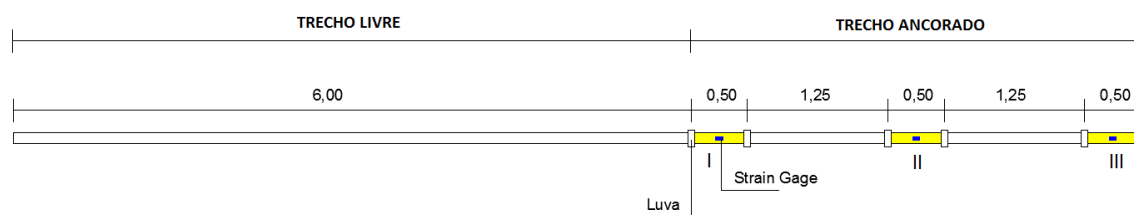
Detalhe da localização das barras instrumentadas ao longo do tirante.
